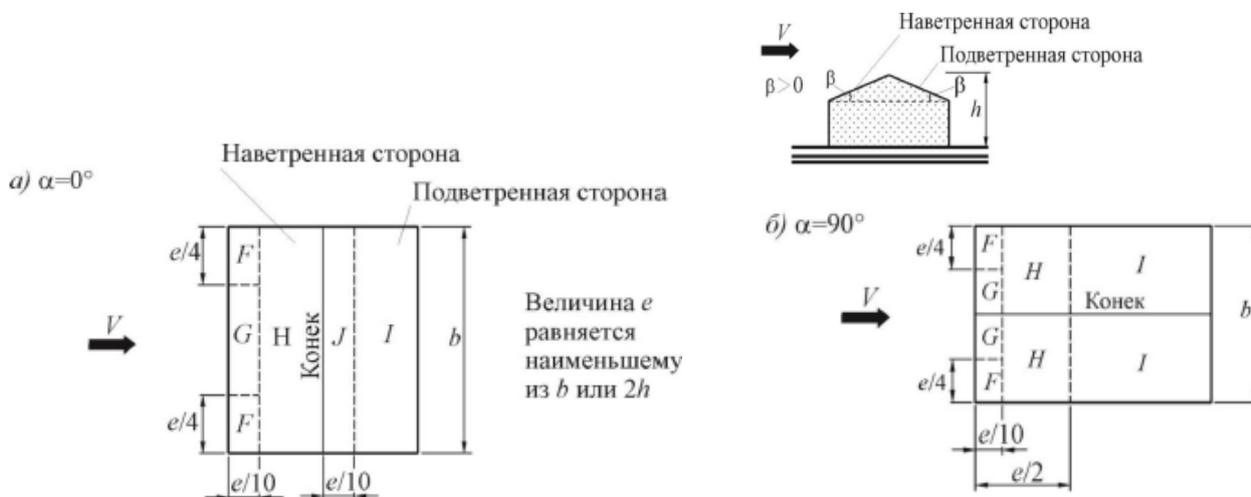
Варианты распределения ветровых нагрузок на двускатную кровлю
